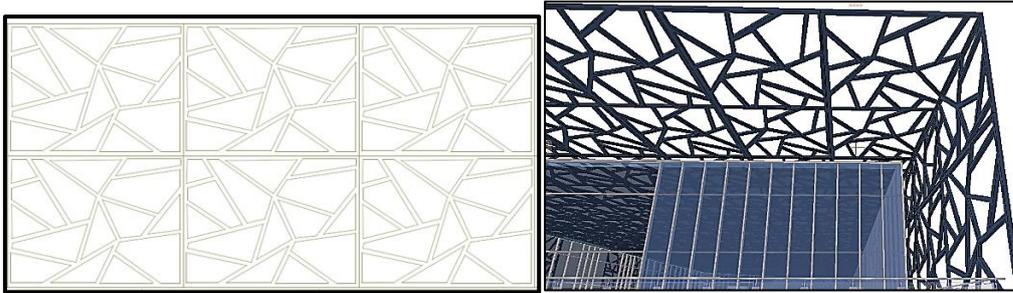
Le Principe de juxtaposition des panneaux de résille.⁷⁹
